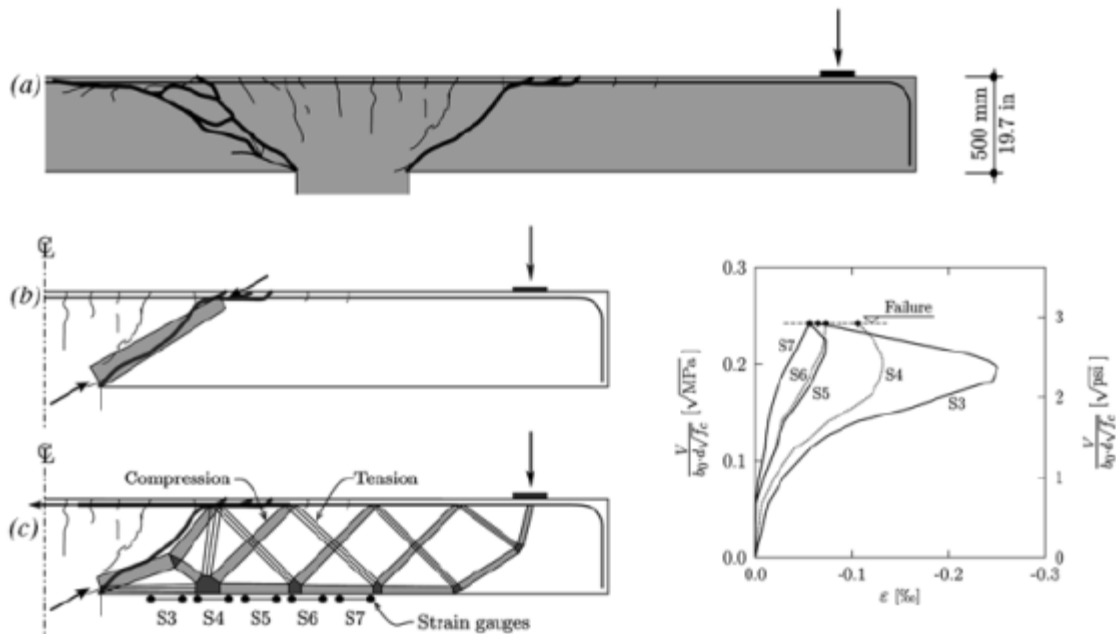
Modelo de bielas e tirantes para ruptura por punção: a) Padrão de fissuras de uma laje depois da ruptura; b) Biela teórica e fissura crítica; c) Modelo teórico biela-tirante para ruptura por punção (MUTTONI, 2008)
